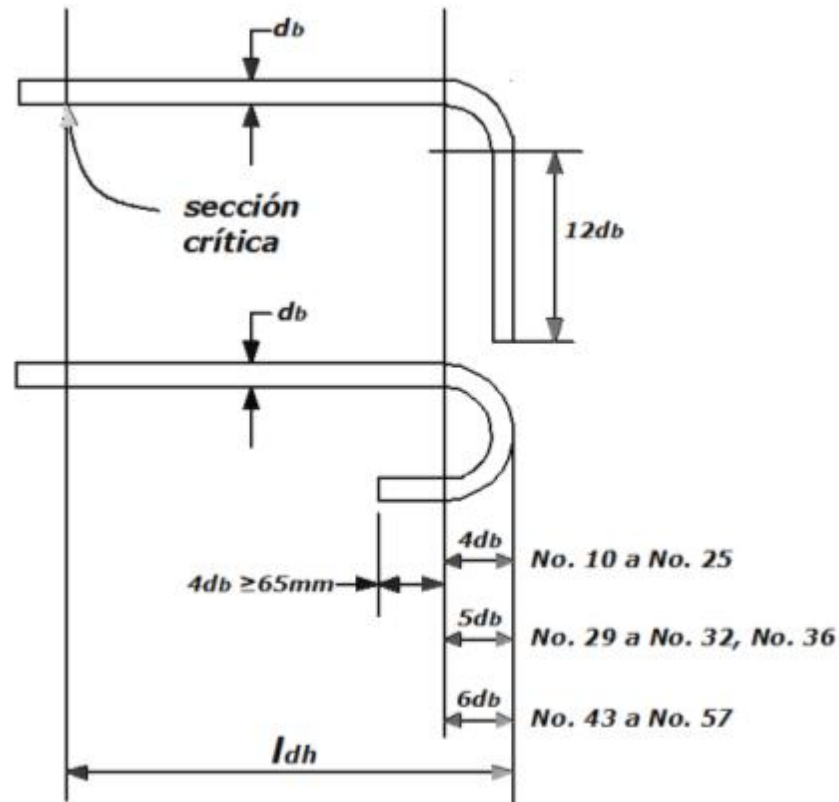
Detalles de barras dobladas para desarrollar el gancho estándar
